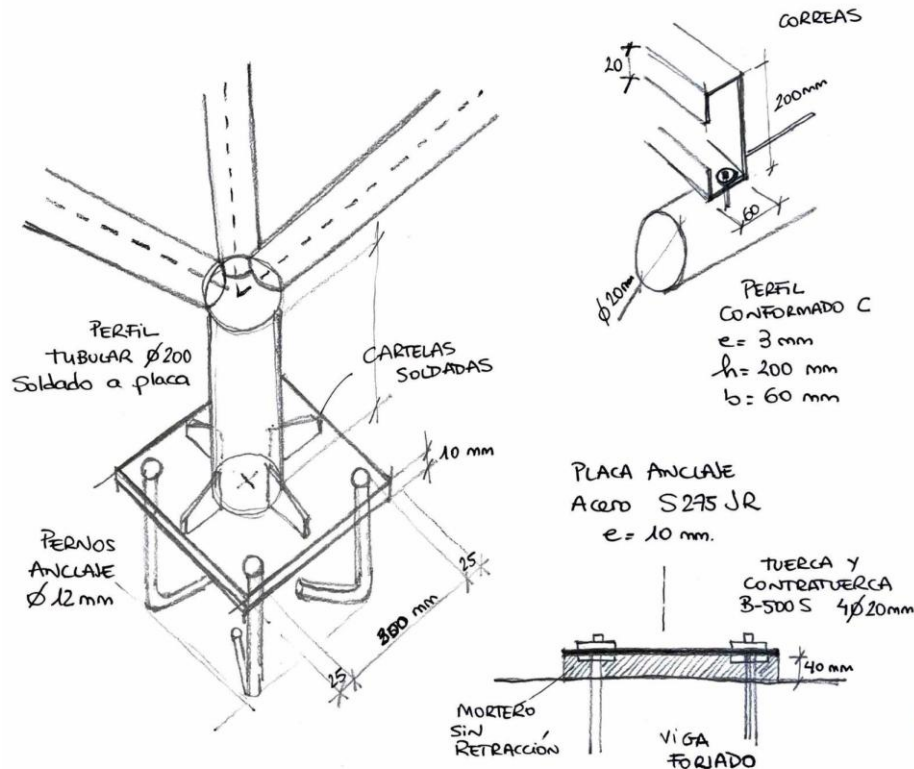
Sistema constructivo anclaje cubierta metálica
